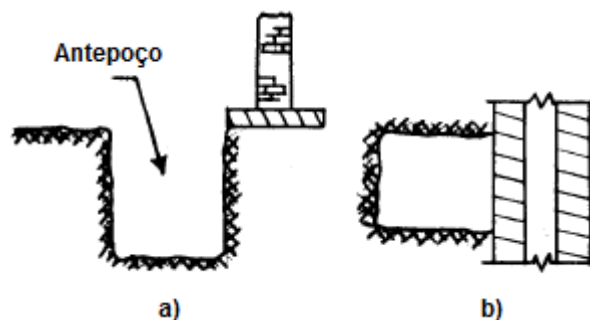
Execução do antepoço: a) alçado; b) planta [32]
